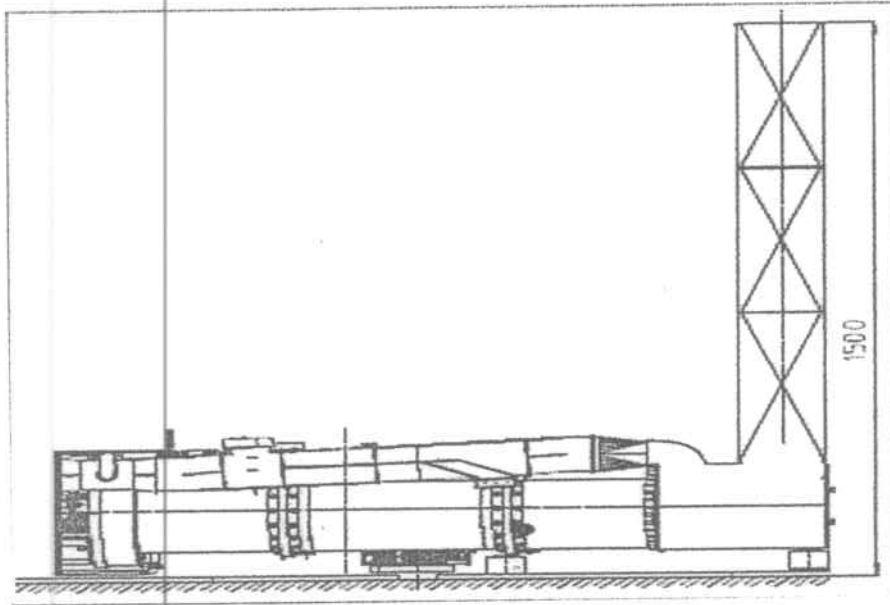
Esquema de la chimenea Planta EMMA LTDA.
